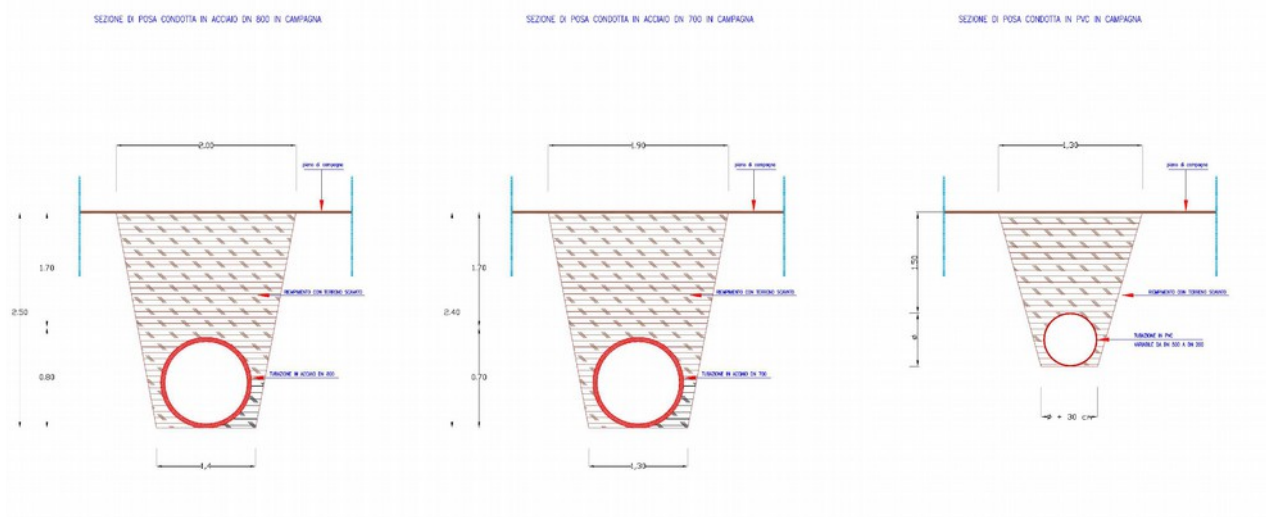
Stralcio della TAV 9 di progetto, con la sezione della posa delle tubazioni
